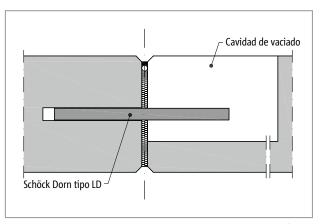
Schöck Dorn: Formación de juntas de expansión en balcón prefabricado
